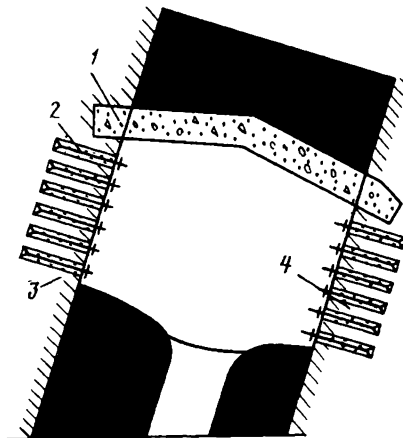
Схема крепления расчески для монтажа щитового перекрытия
